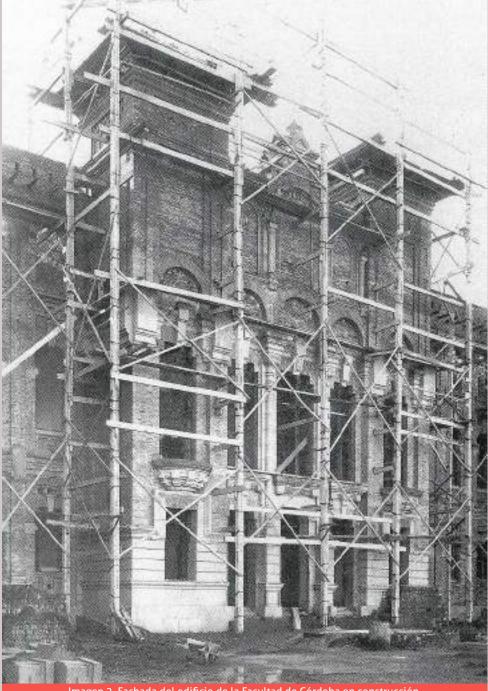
Fachada del edificio de la Facultad de Córdoba en construcción. Fundada en 1847. (Medina Blanco y Gómez Castro, 1992)
